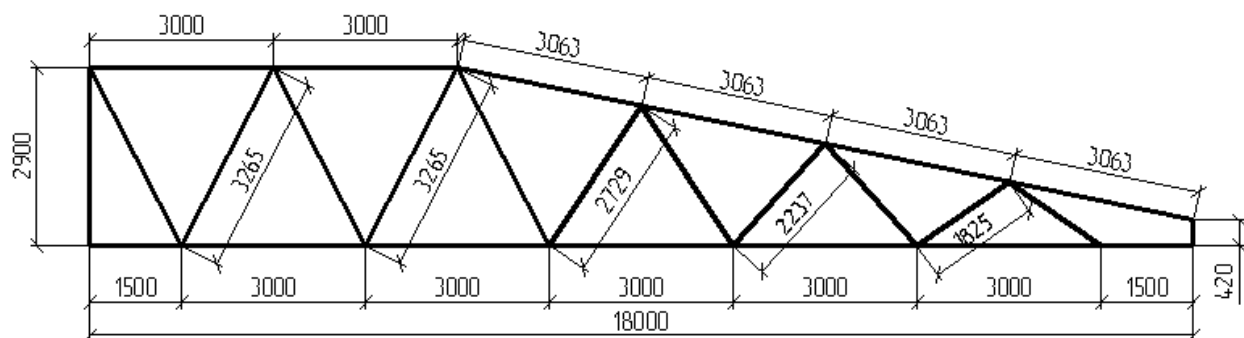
Геометрические размеры фермы покрытия Фм-2
